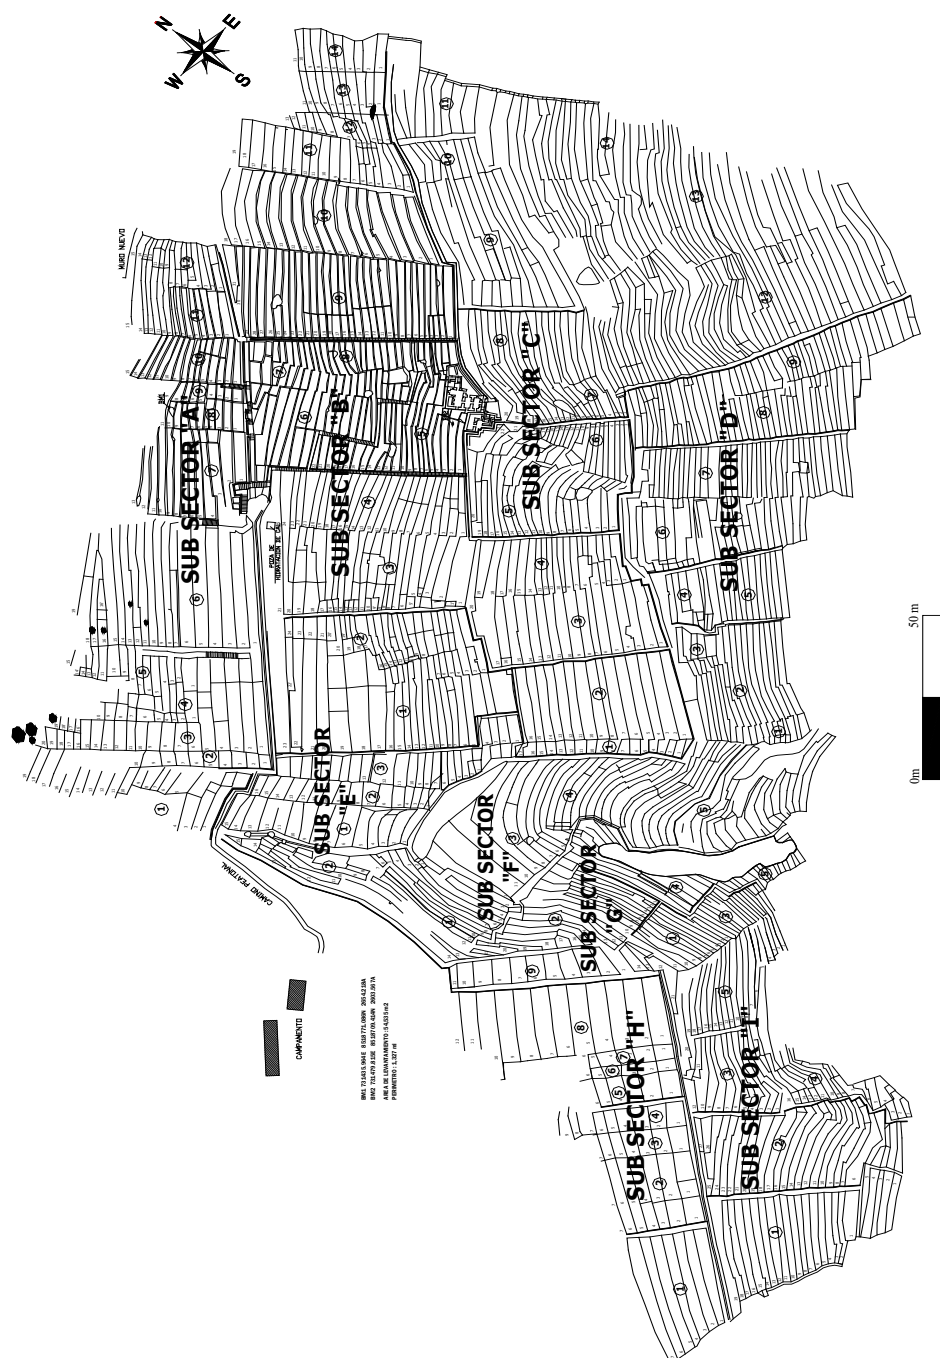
Plano del sector XI (Fuente Plan COPESCO 2004)
